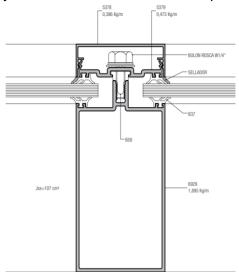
| Detalle de perfil de aluminio horizontal y vertical con DVH.
